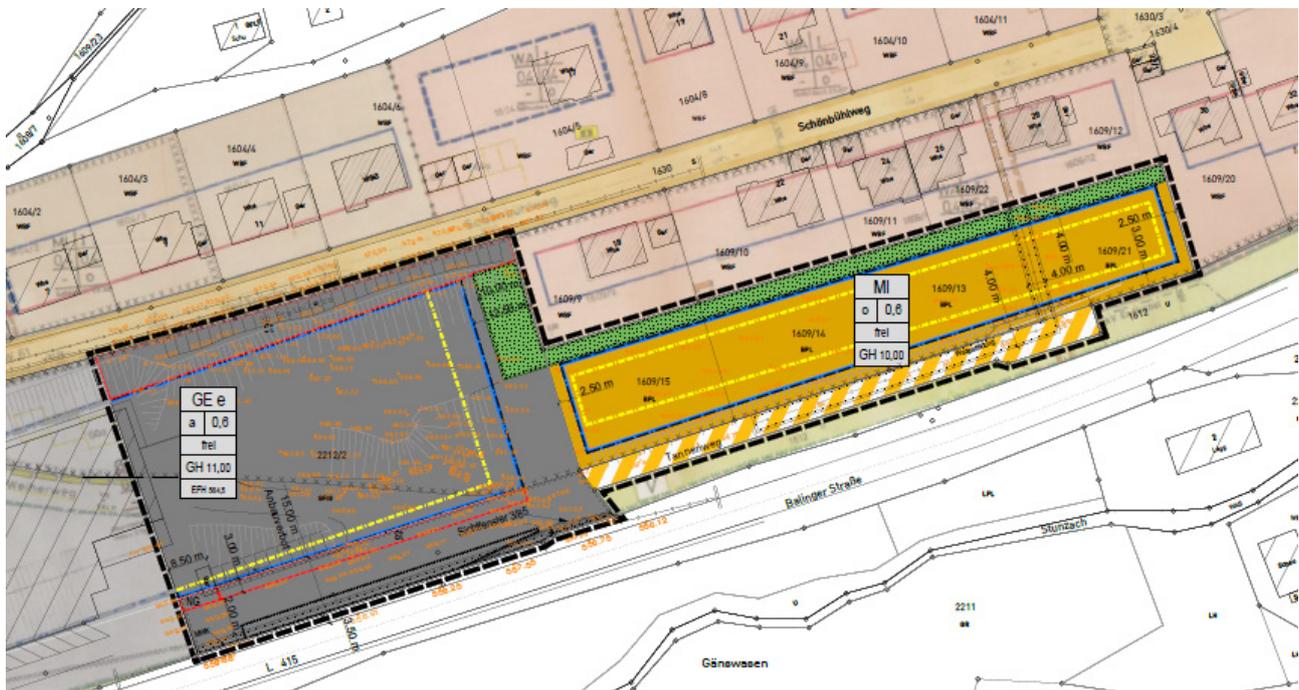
Geplante Bebauungsplanänderung „Schönbühl, 3. Änderung“
